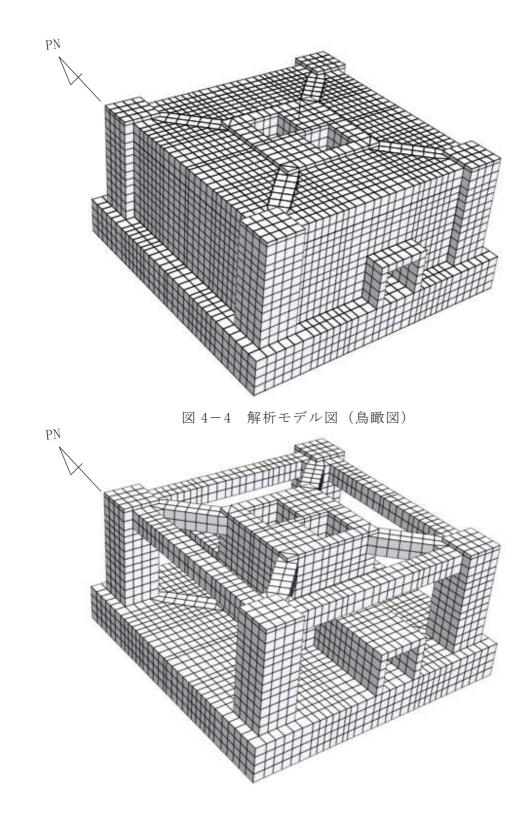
解析モデル図(鳥瞰図(充填コンクリート非表示))
